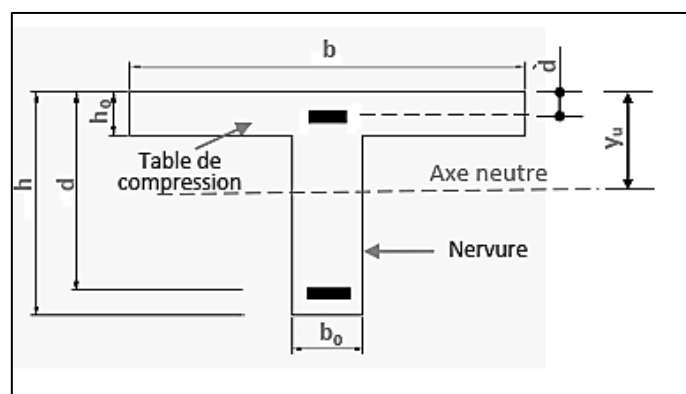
Élément en béton armé de section en forme d'un T
